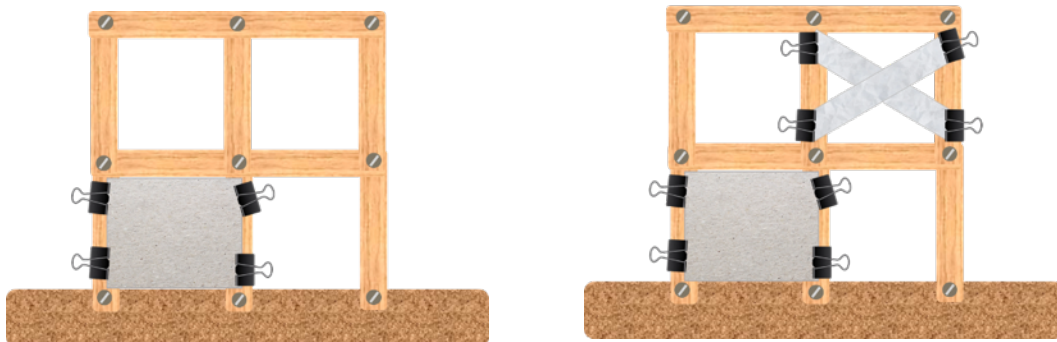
Pórtico reforzado. Izquierda: primer piso reforzado con el cartón cuadrado, derecha: primer piso del pórtico reforzado con el cartón y segundo piso con papeles.
